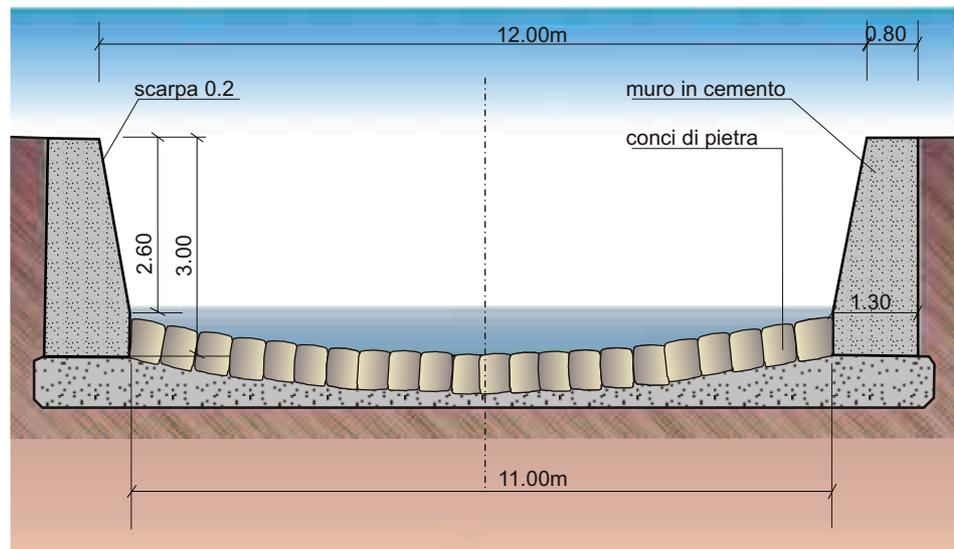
Nello schema a fianco è raffigurato un cunettone con muri di sponda e fondo in calcestruzzo rivestiti in pietrame. Il pietrame oltre a migliorare l'impatto visivo dell'opera ha la funzione di proteggere il calcestruzzo dall'abrasione e dagli urti dovuti al materiale, anche di grosse dimensioni, in carico alla corrente.
